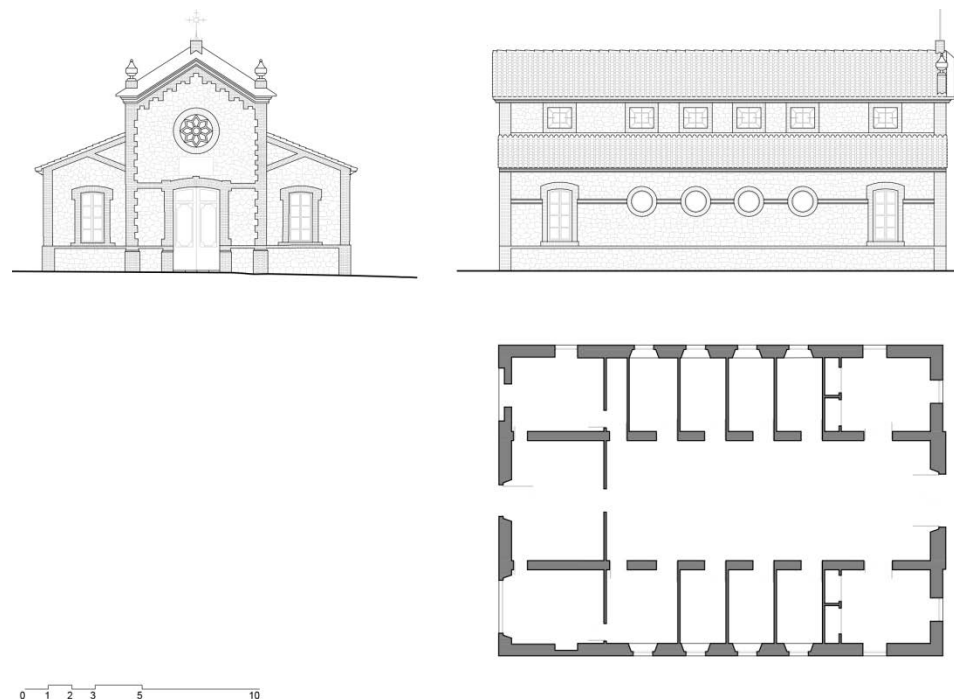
Levantamiento Planimétrico del Pabellón de Baños. Fase 1 (1913-1922)
